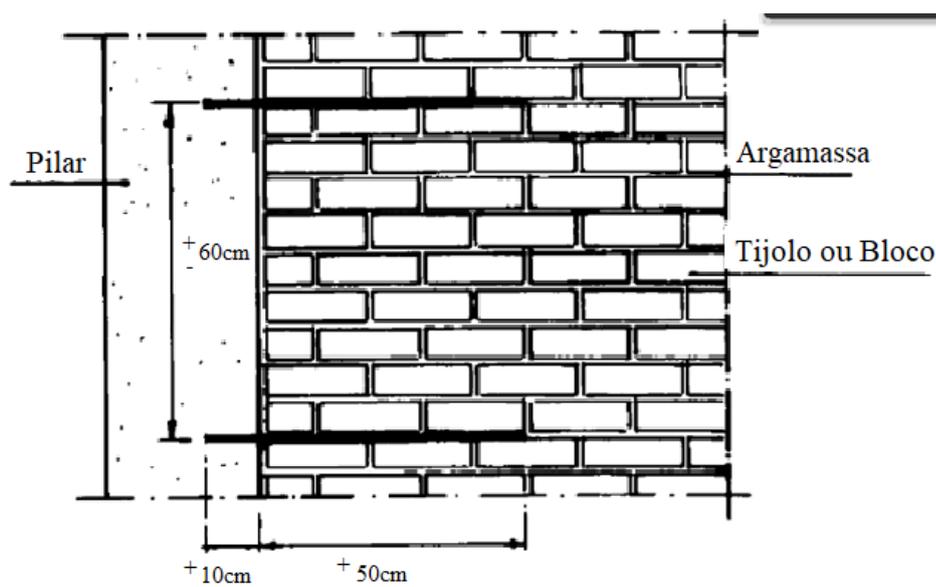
Ligação entre alvenaria e pilar de concreto armado.
